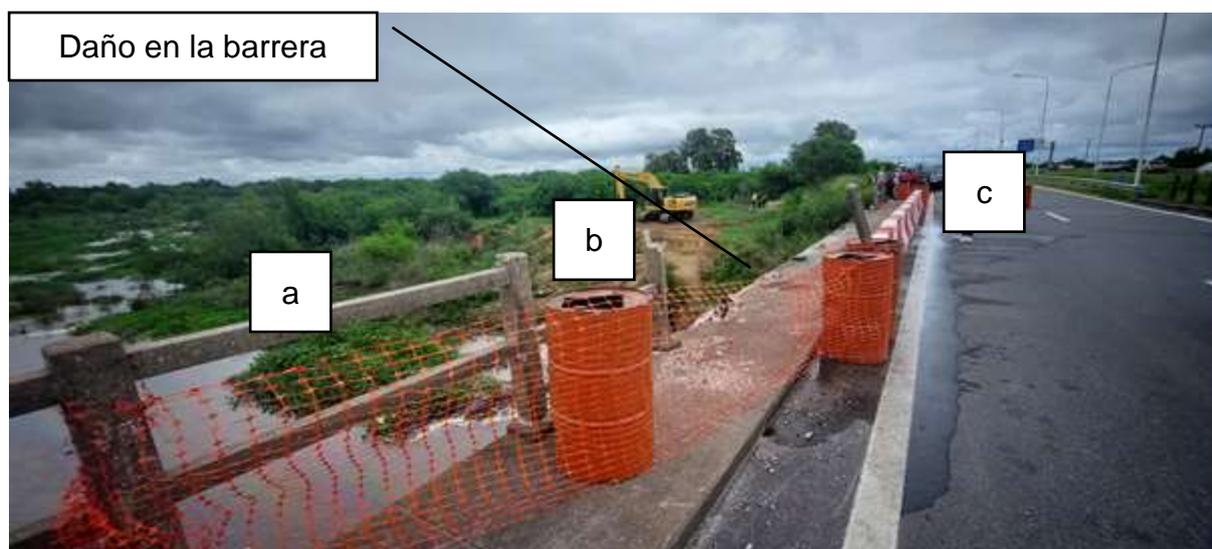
Daños sobre el puente y dispositivo de señalamiento en la zona de choque. a) Malla o cerco plástico reticulado; b) Tachos metálicos color naranja; c) Barreras viales plásticas, tipo New Jersey.
